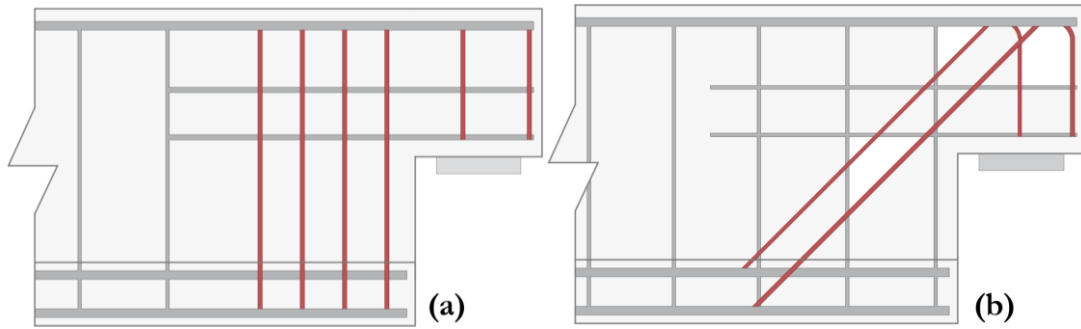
Layout armature travi testate: (a) Trave A (b) Trave B
